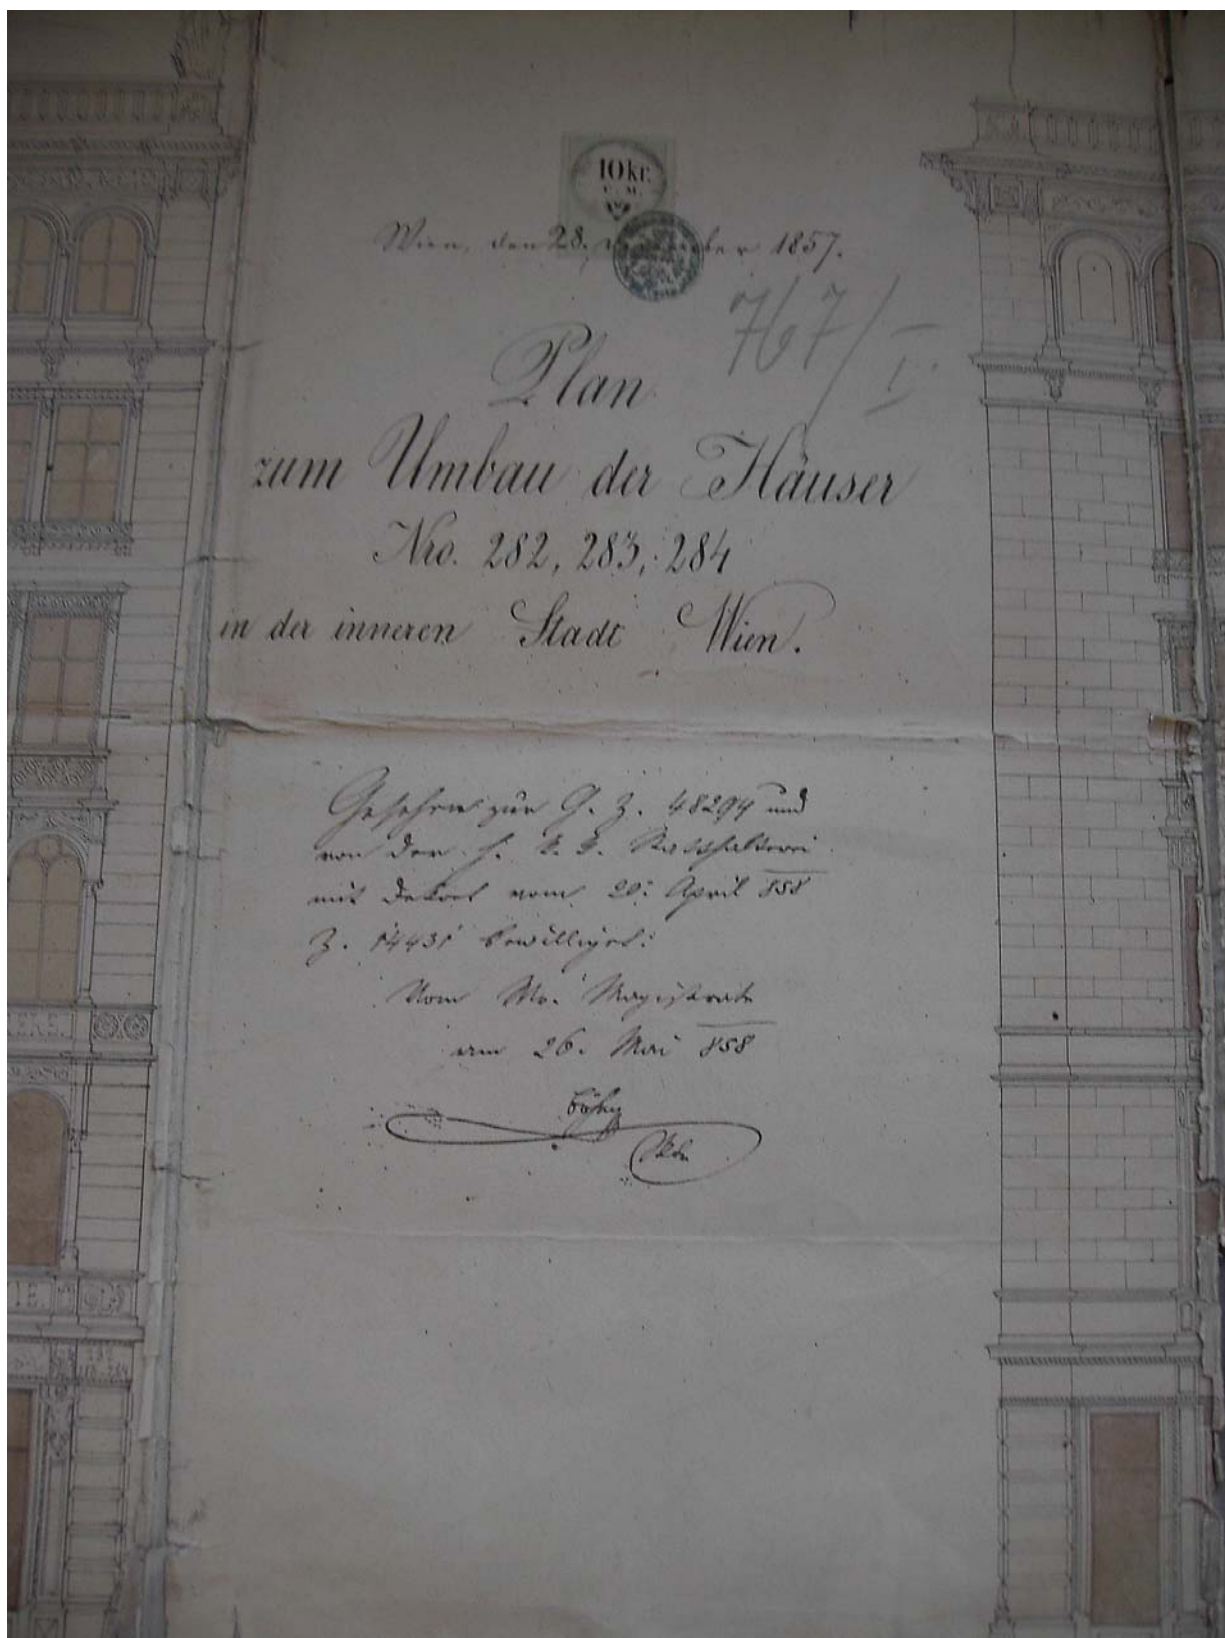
Einreichplan zum Haus Liebieg, 28. 11. 1857, Detail: Baubewilligungsvermerk.
